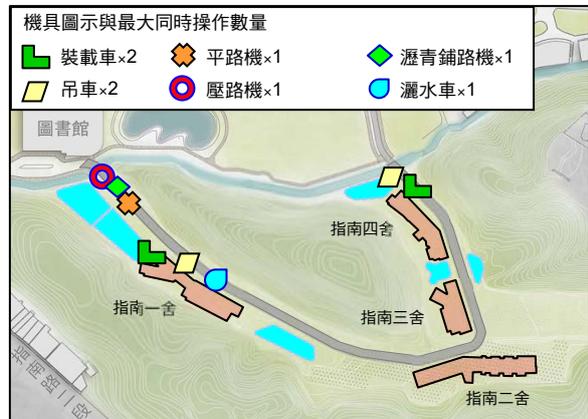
變更後宿舍區施工階段主要施工機具配置示意圖
